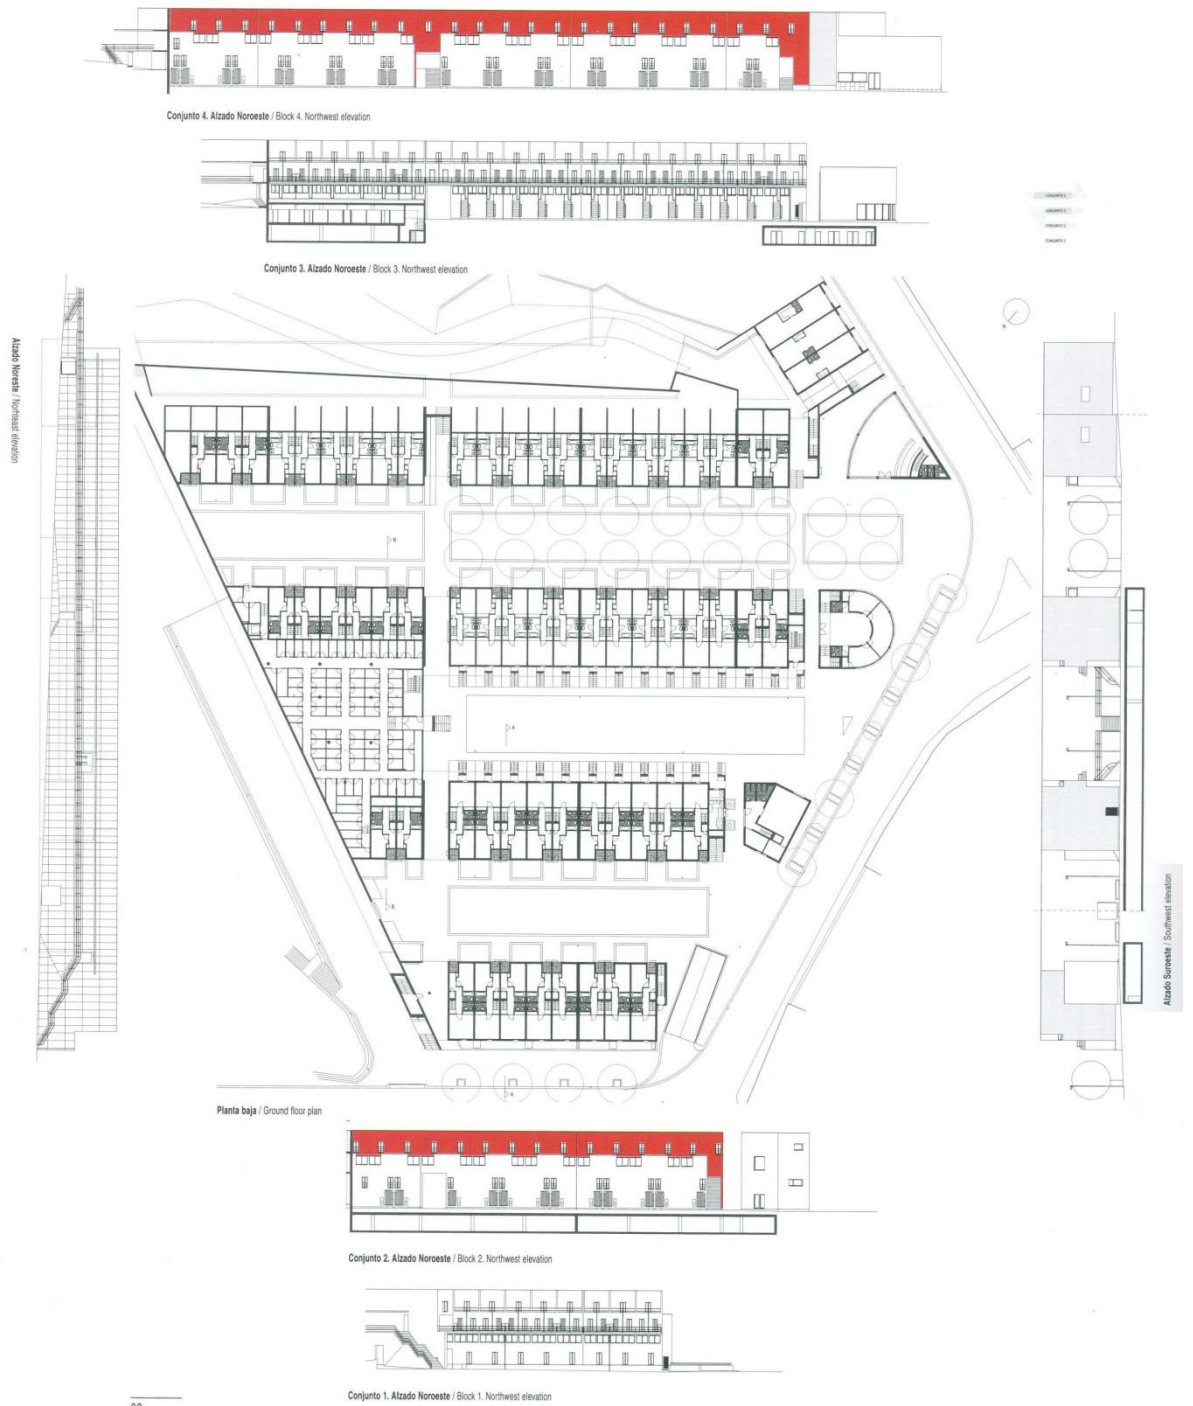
PLANTA PRIMEIRO PAVIMENTO E ELEVAÇÕES - BOUÇA
